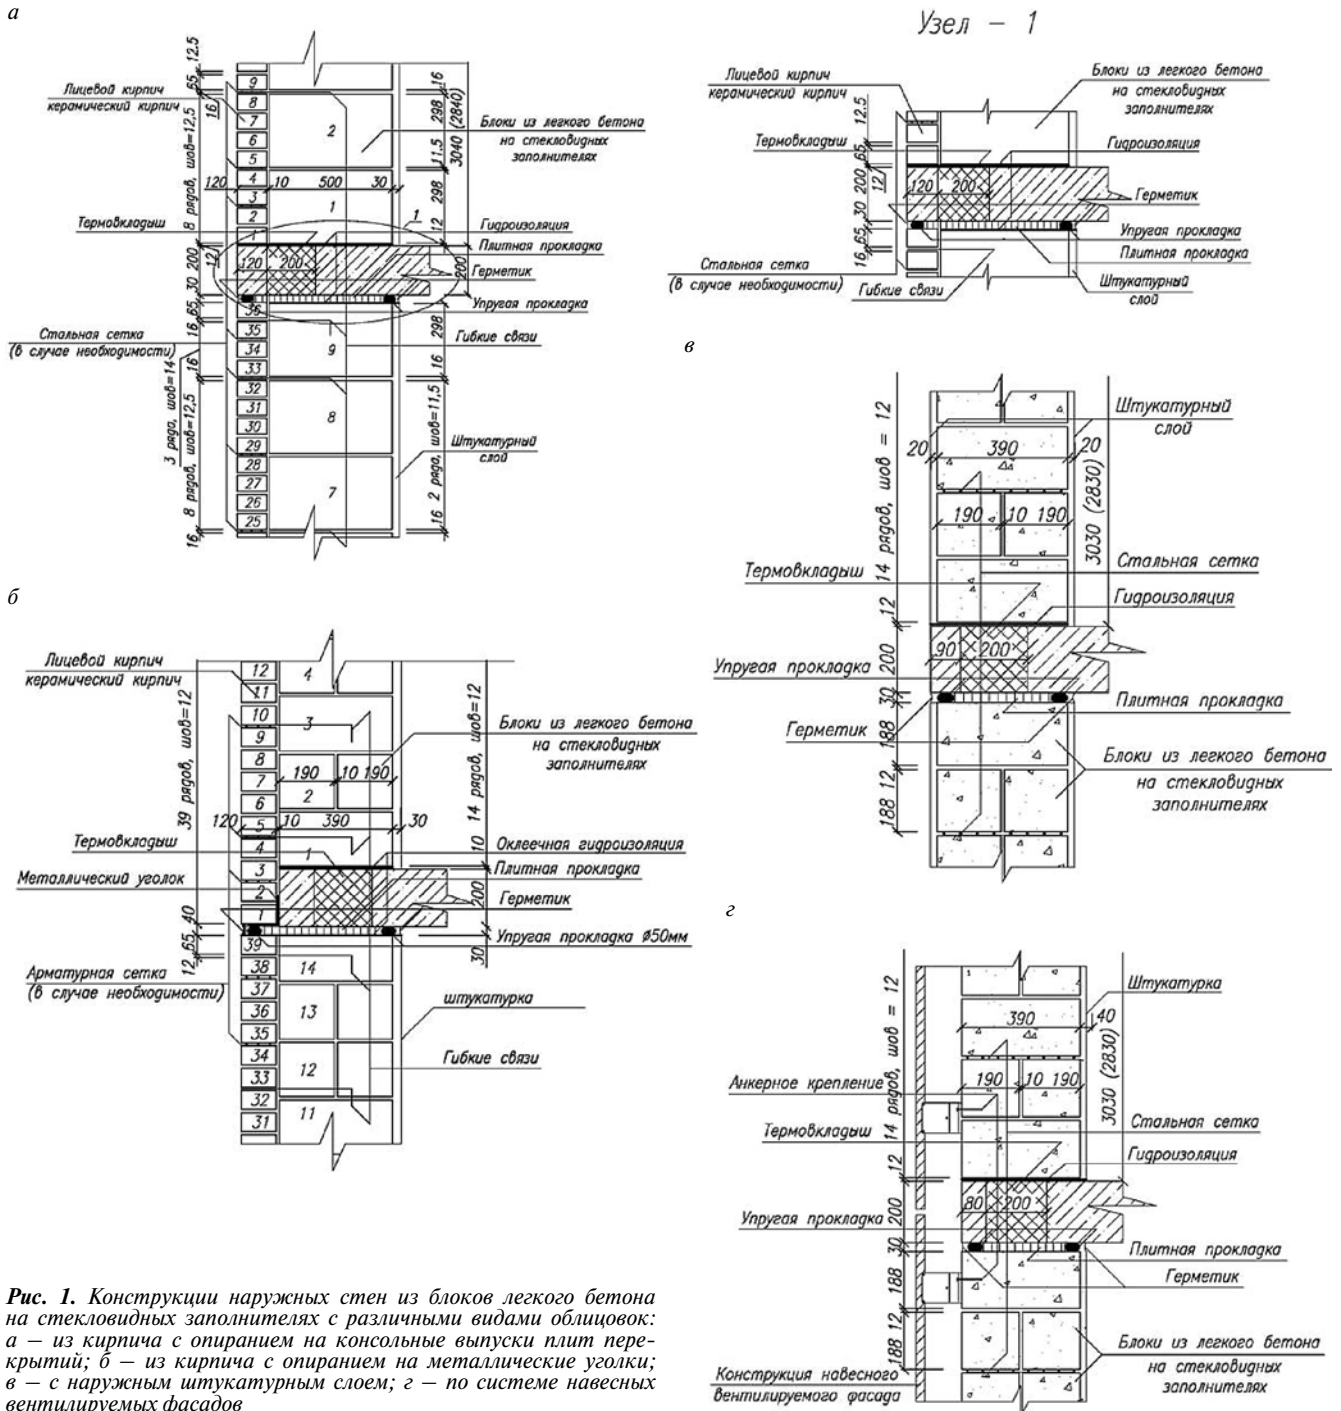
Конструкции наружных стен из блоков легкого бетона на стеклобидных заполнителях с различными видами облицовок: *а* – из кирпича с опиранием на консольные выпуски плит перекрытий; *б* – из кирпича с опиранием на металлические уголки; *в* – с наружным штукатурным слоем; *г* – по системе навесных вентилируемых фасадов
